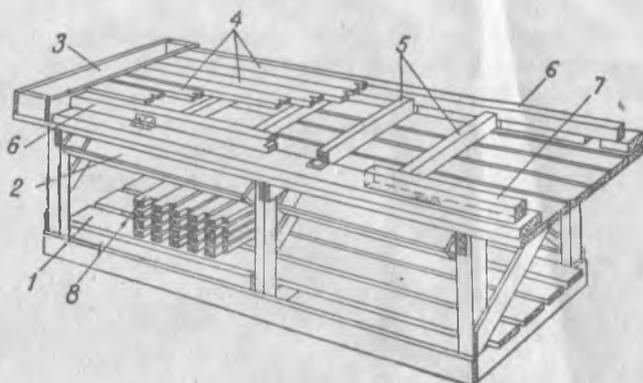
Верстак стахановцев Глущенко и Гергелевича для сборки щитов подбора:
